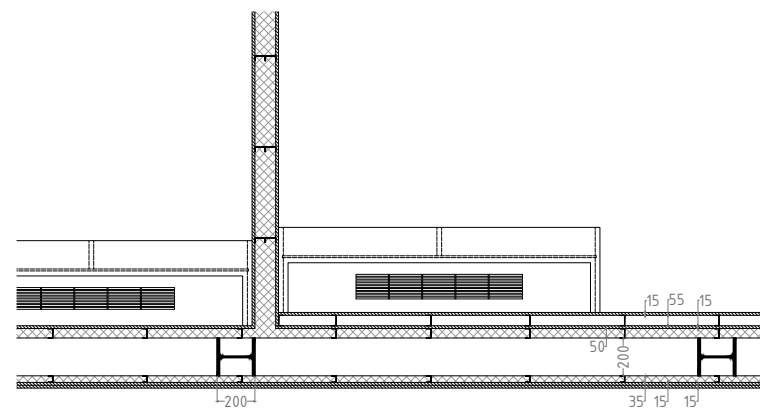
Detalle tipo dos ventiloconvectores instalados nos armarios. Escala 1/20.
